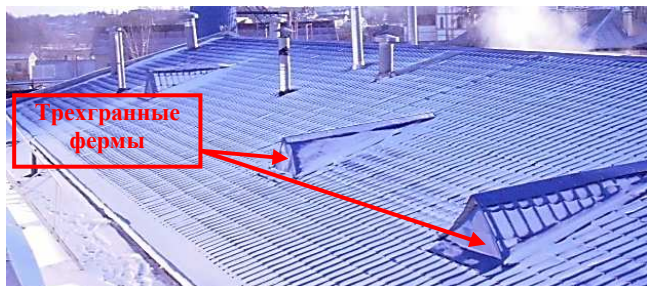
Общий вид кровли цеха после устройства трёхгранных стальных ферм в чердачном пространстве
